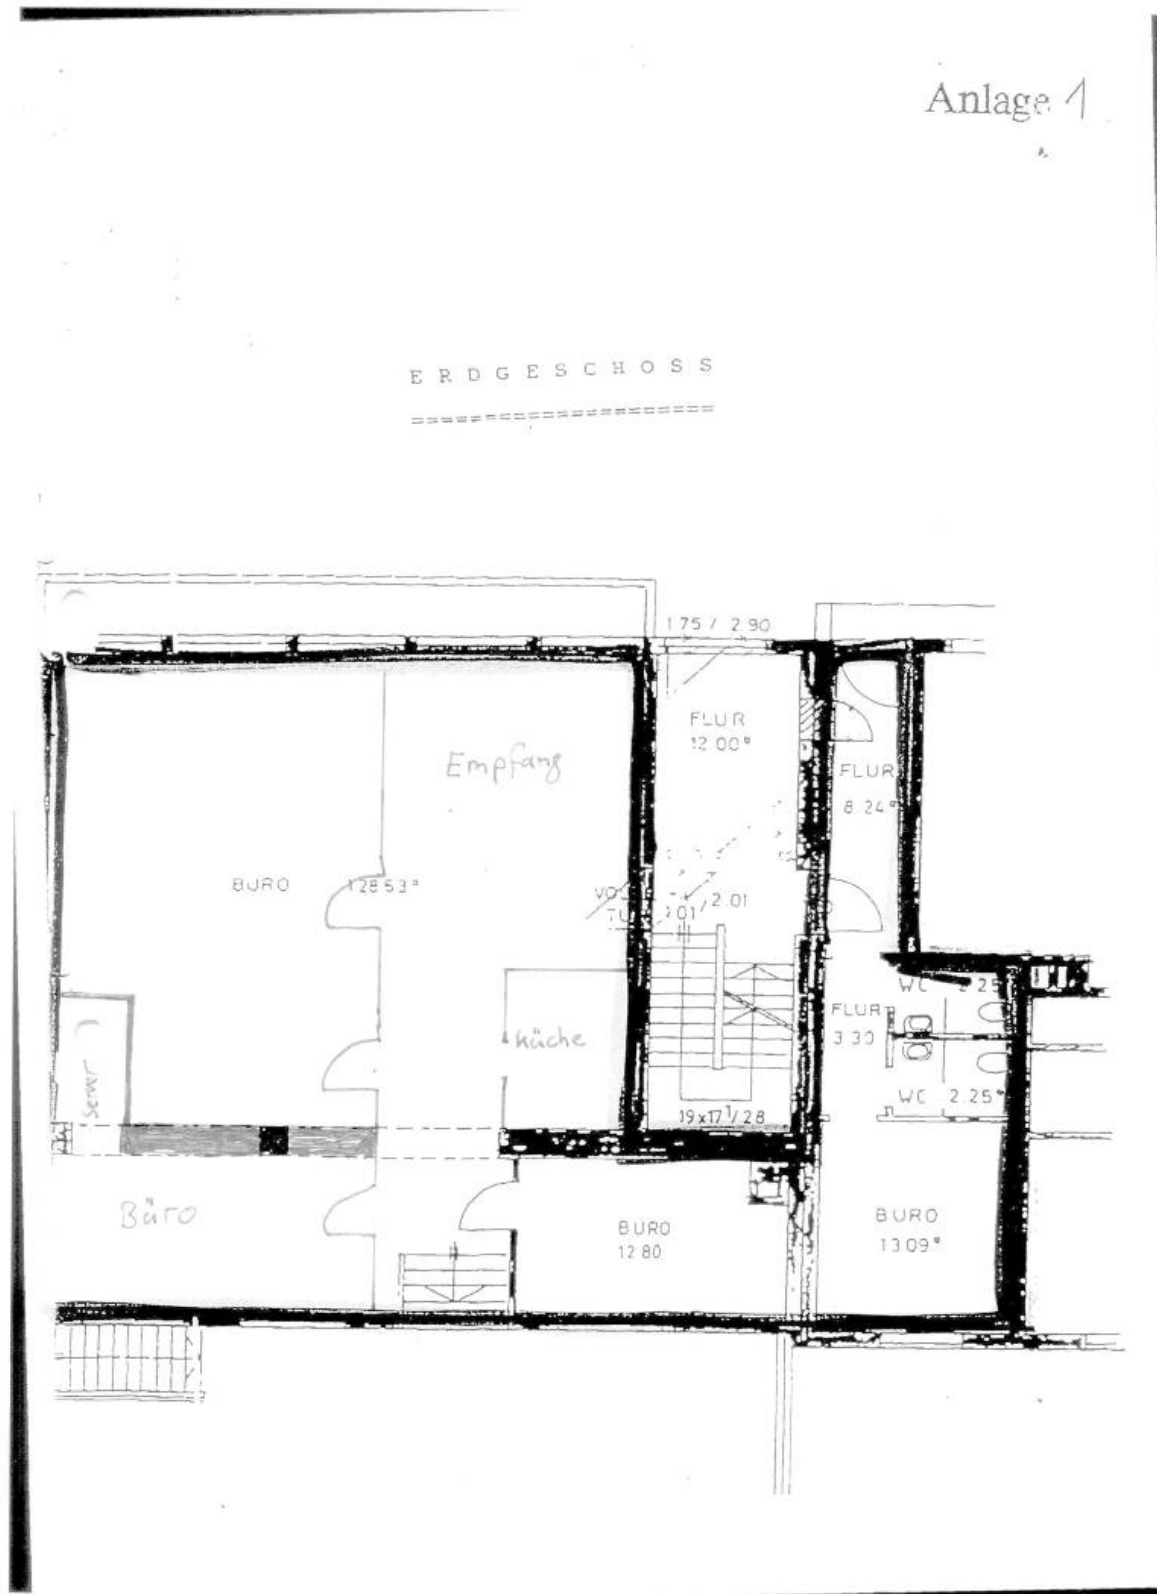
Grundriß vom Erdgeschoß des Objekts "Schopenhauer Straße 71"
